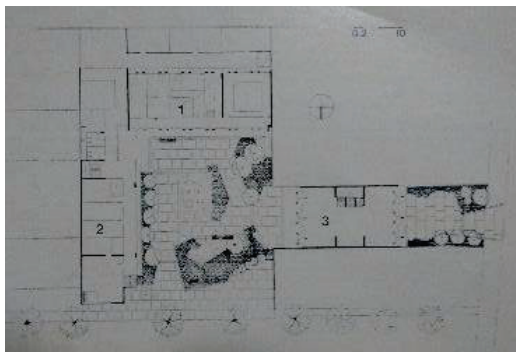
Emplazamiento. 1. Facultad de Arquitectura. 2. Facultad de Ingeniería. 3. Facultad de Abogacía
